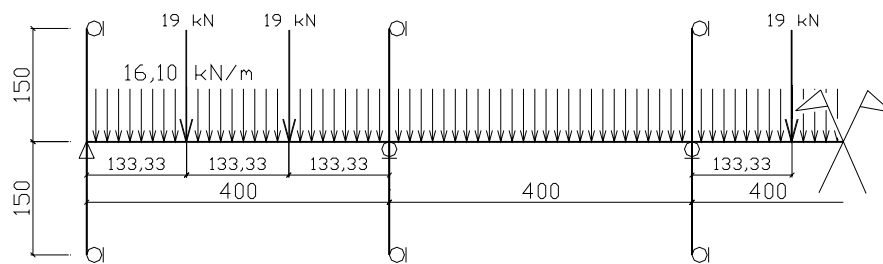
Esquema estrutural e de carregamento, Caso 8 (dimensões em cm)
